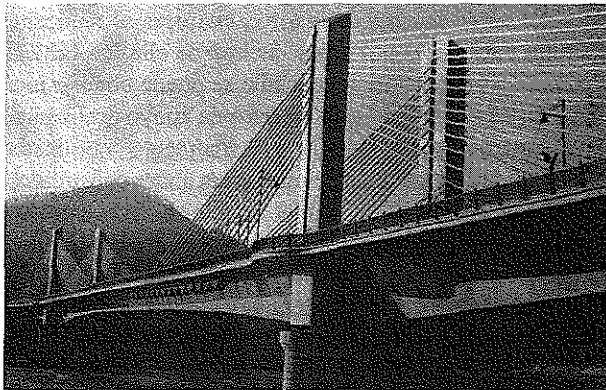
Puente de hormigón con pretensado extradosado. El puente de Tsukuhara, Japón (1998).
